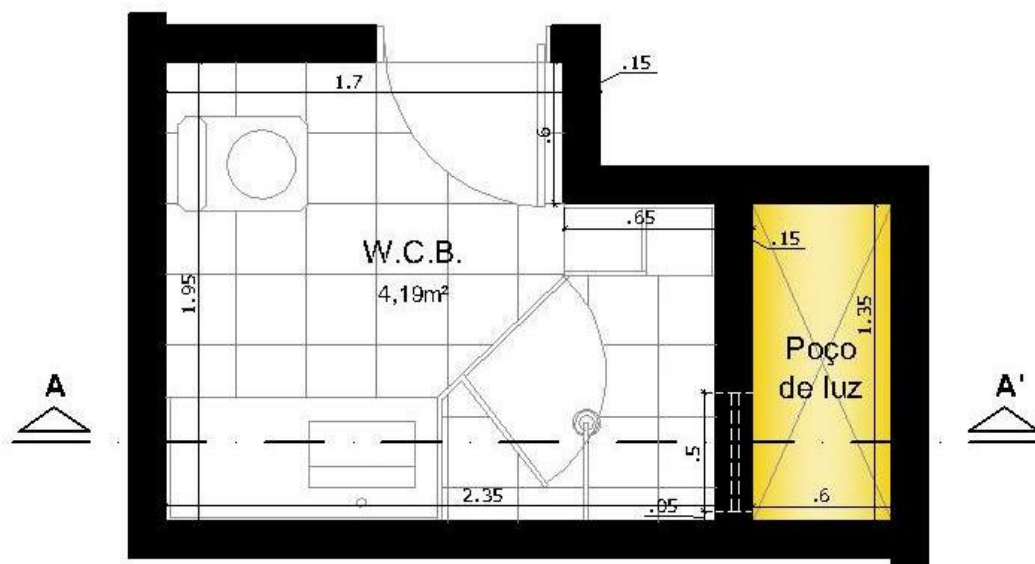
Planta Baixa do banheiro com o poço de luz.
